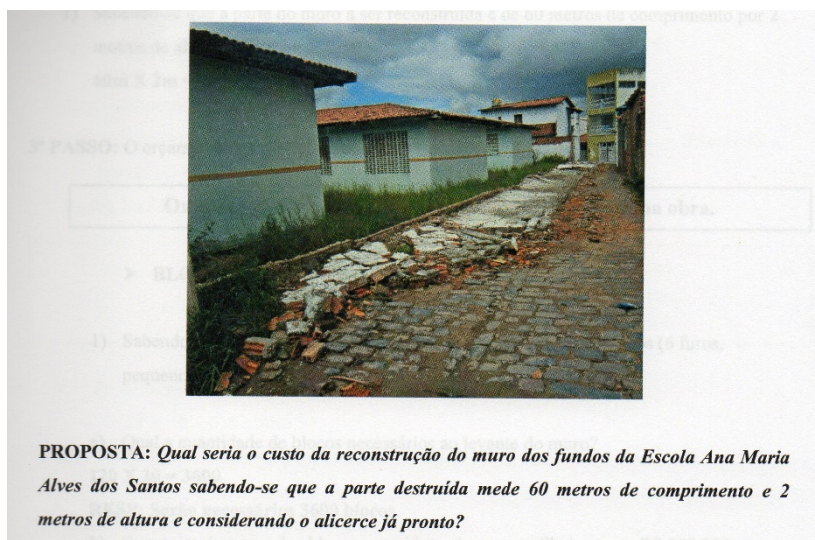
Situação-problema retirada do guia do planejamento da professora Márcia
